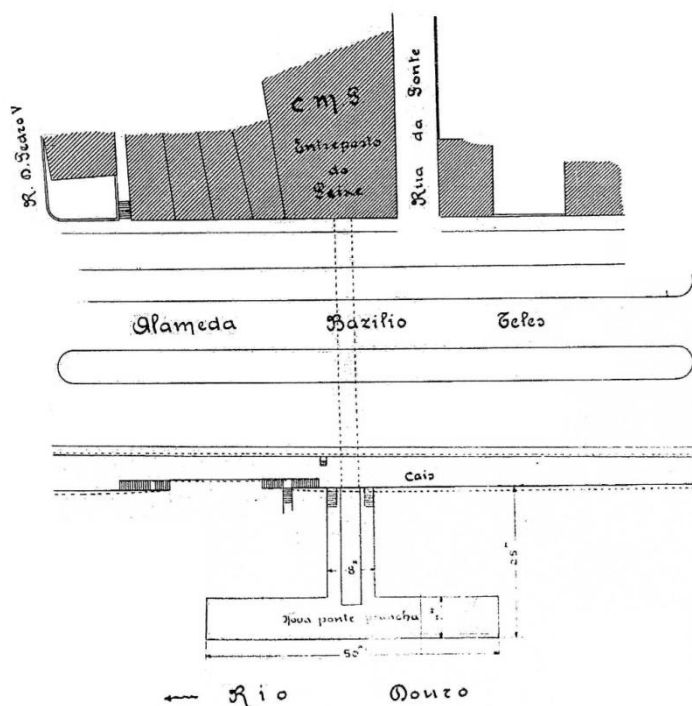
Prancha e sistema mecânico de ligação à Bolsa do Pescado
